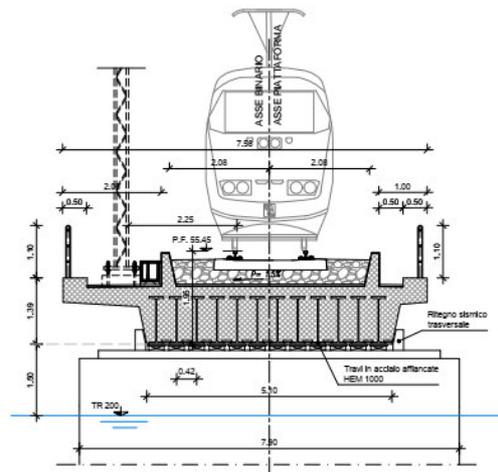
Ponte a travi incorporate IN46 – Sezione trasversale impalcato
